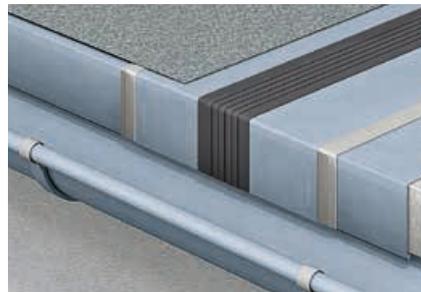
Borde de cubierta con función estanca y drenaje externo
